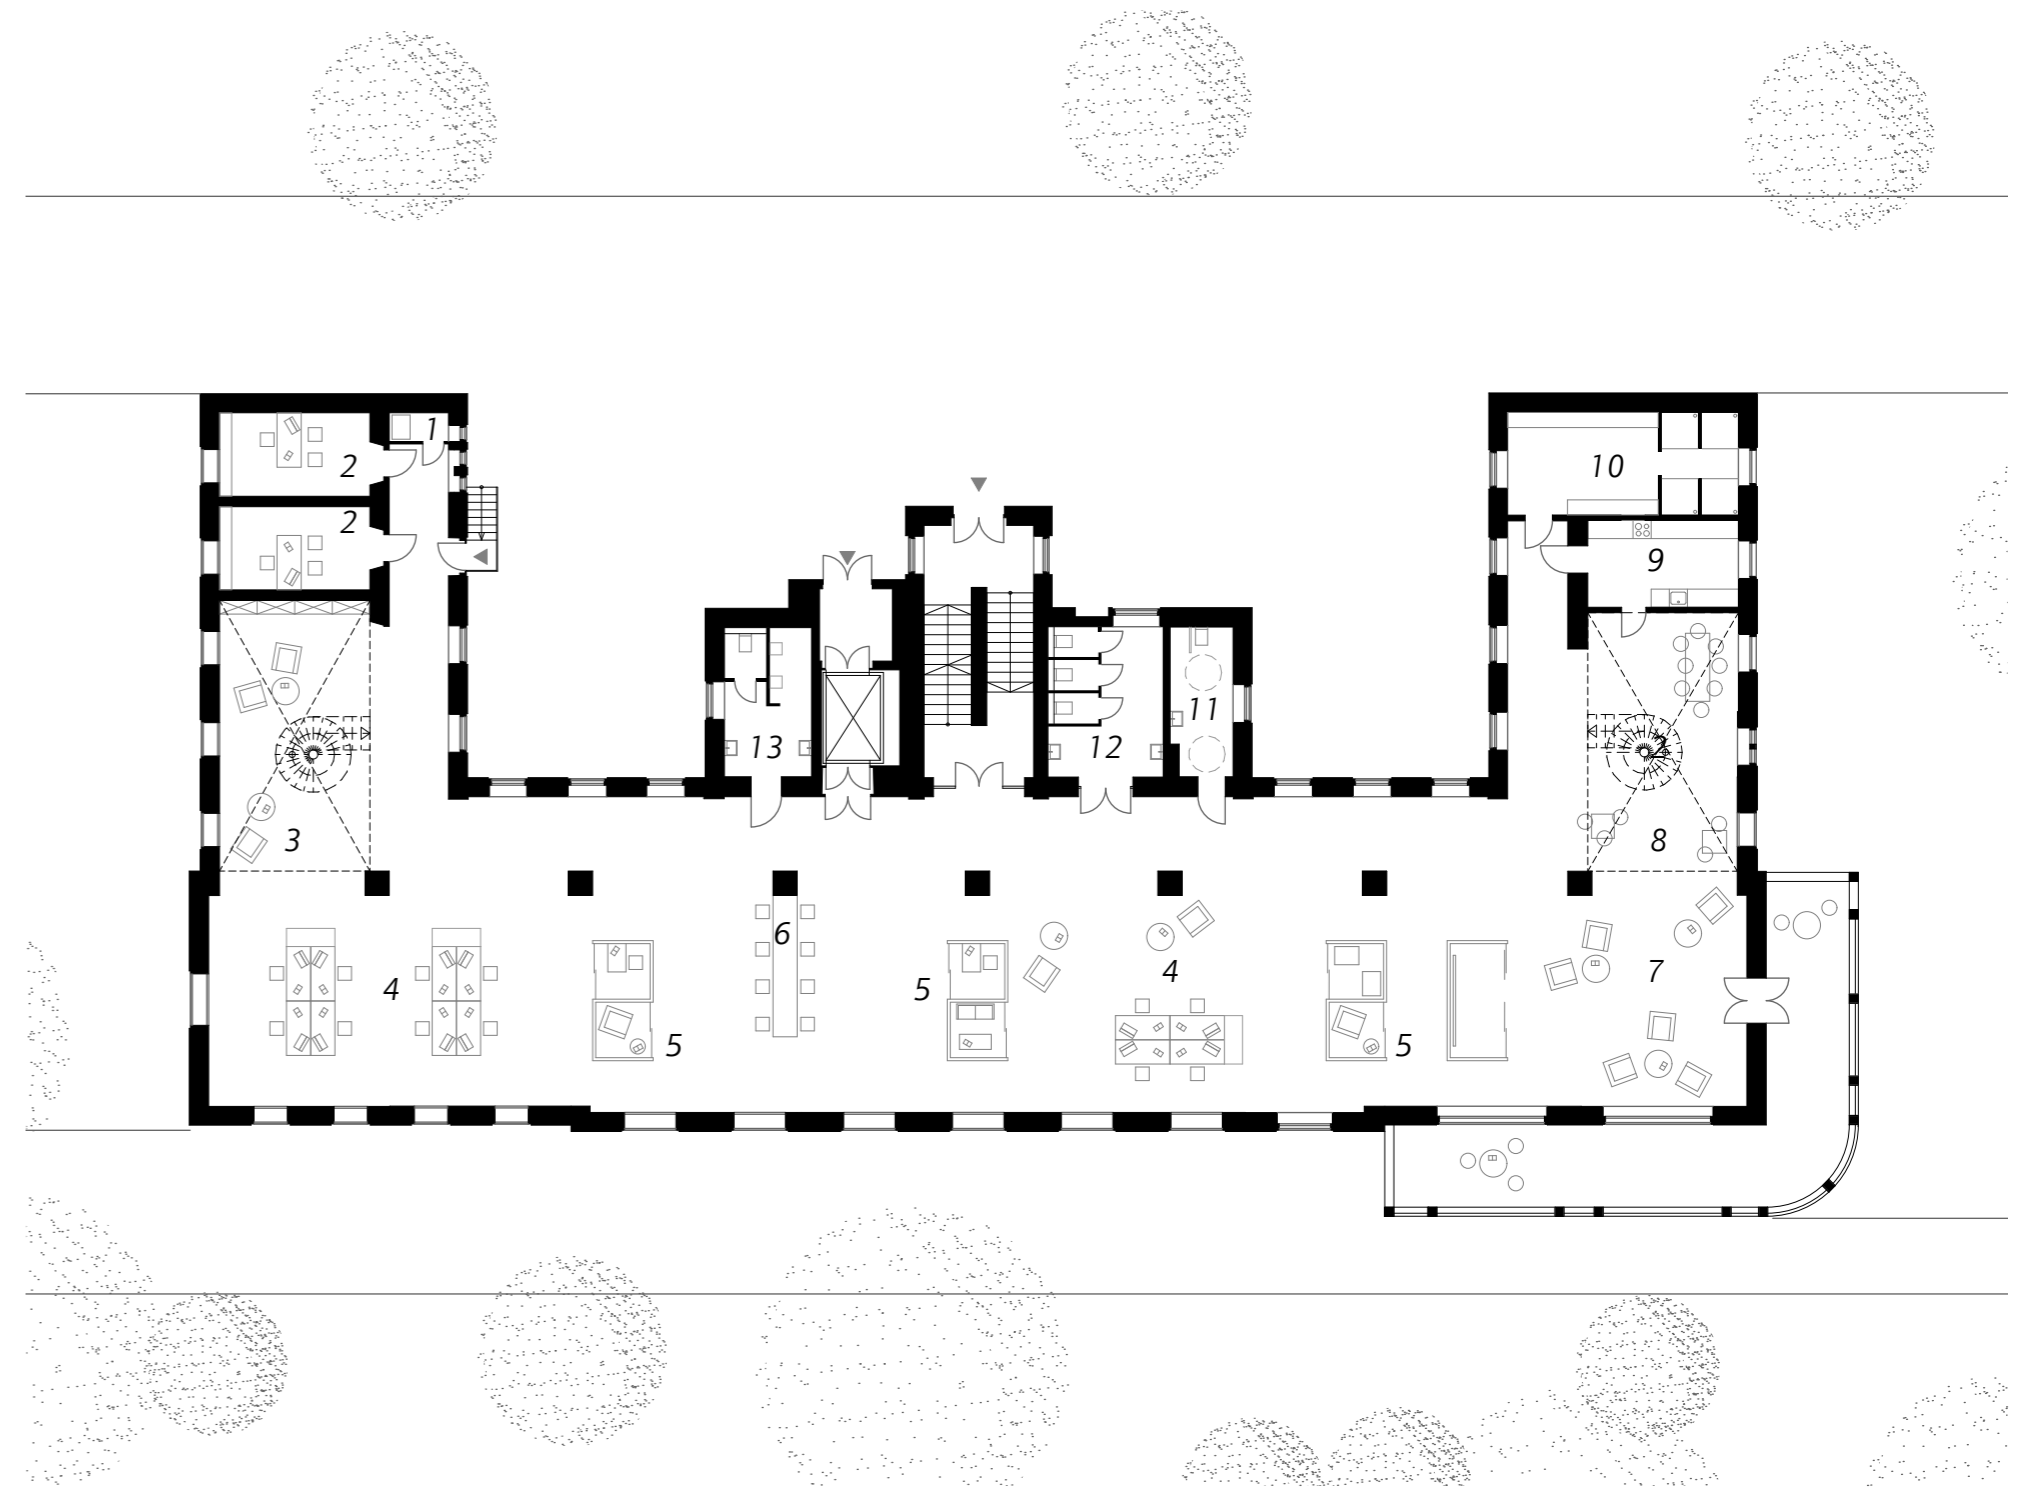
Grundriss Pavillon 4 | Gartengeschoss | M 1-250
